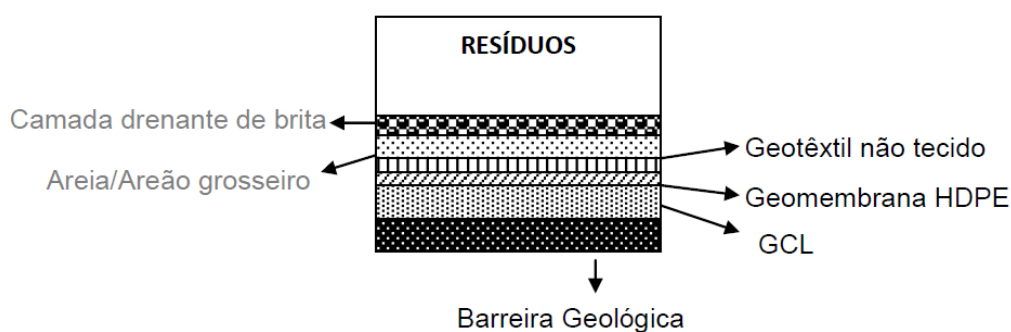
Esquema do Sistema de Impermeabilização da Zona Basal do Aterro Sanitário
